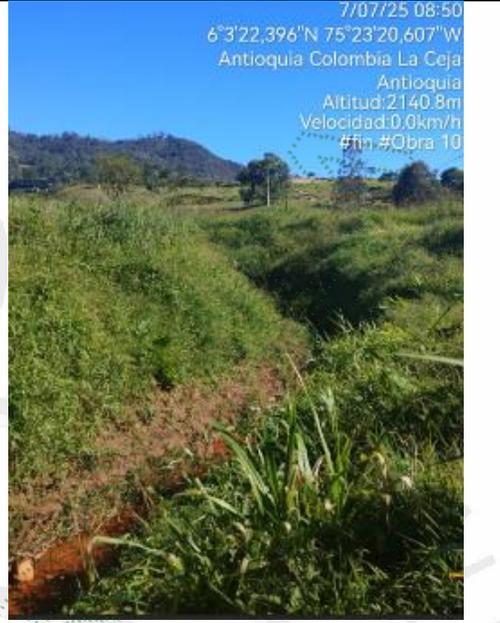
Final Canal Trapezoidal (Obra 10) en Q. Sin Nombre
